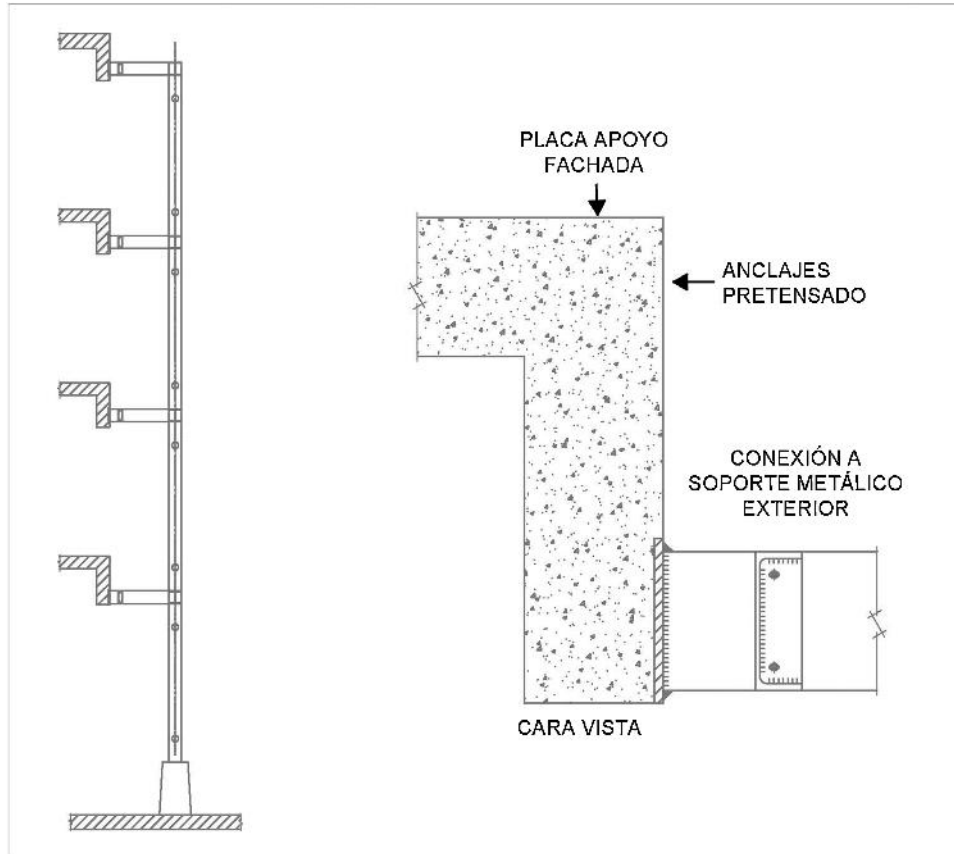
Viga de borde de forjados y unión a soportes metálicos exteriores.
